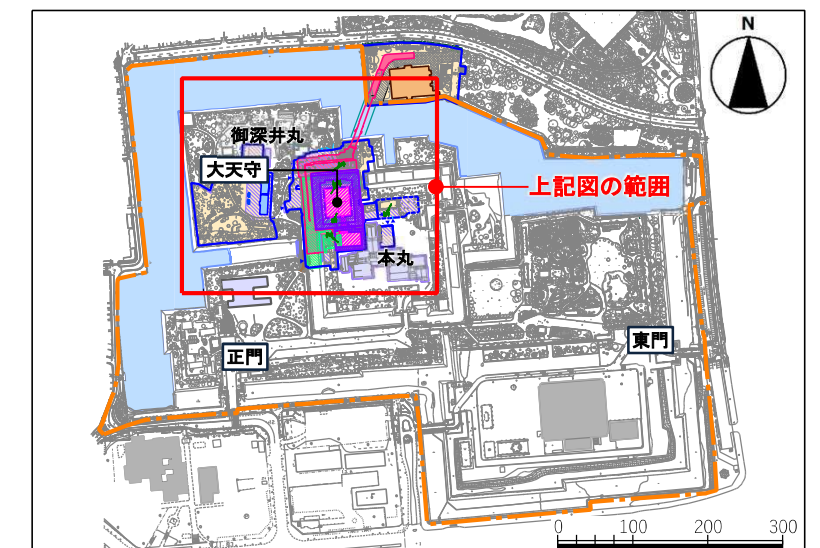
現天守閣解体工事時の平面図(敷地全体)
